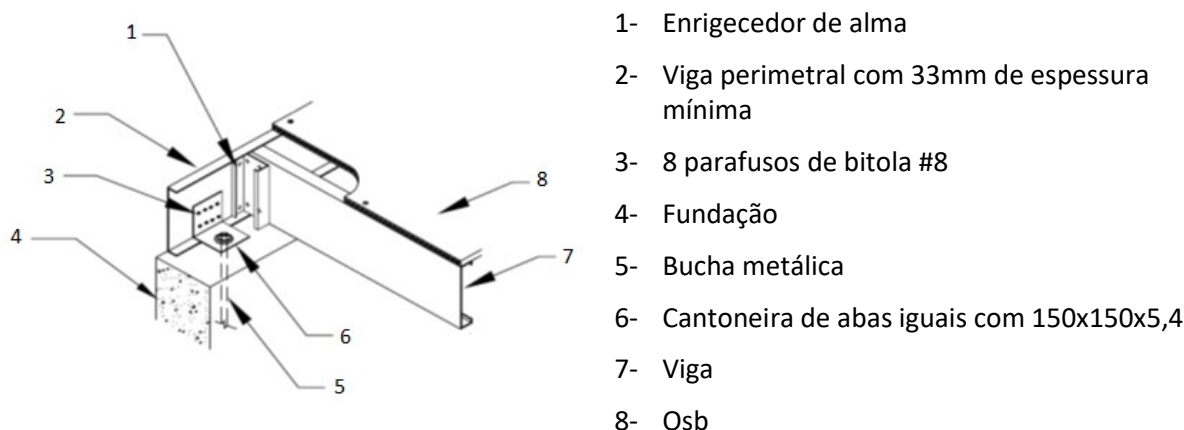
Ligação pavimento de LSF com frechal de pedra (AA.VV., 1997)
